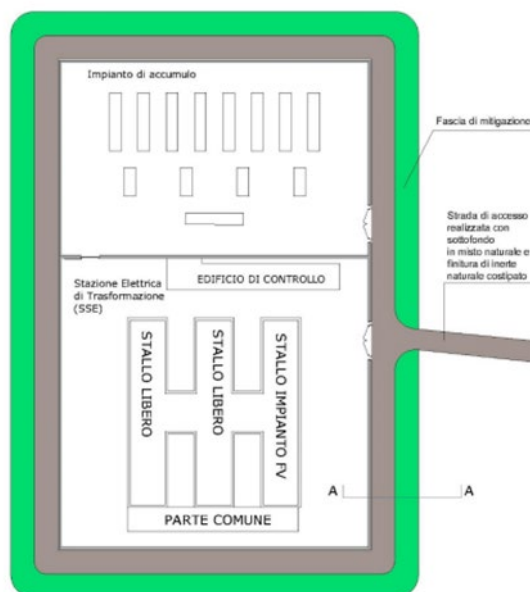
stralcio SSE utente e Storage con fascia di mitigazione
